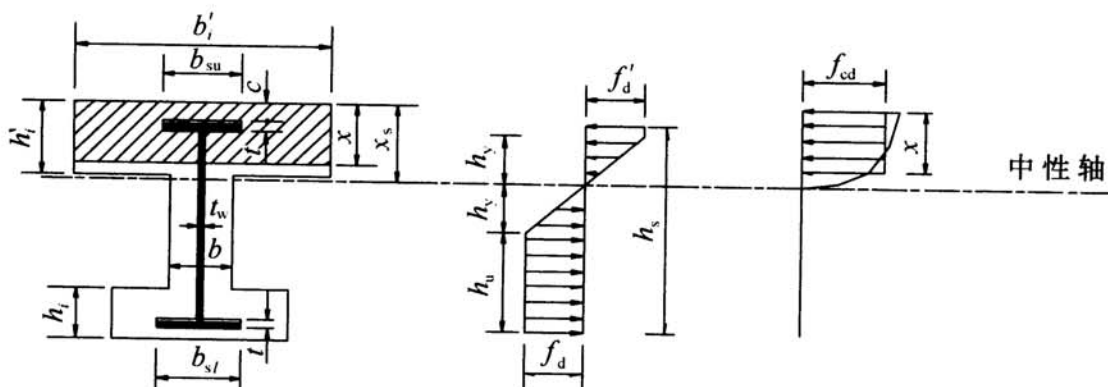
中性轴位于混凝土翼缘板中的截面抗弯计算图式
